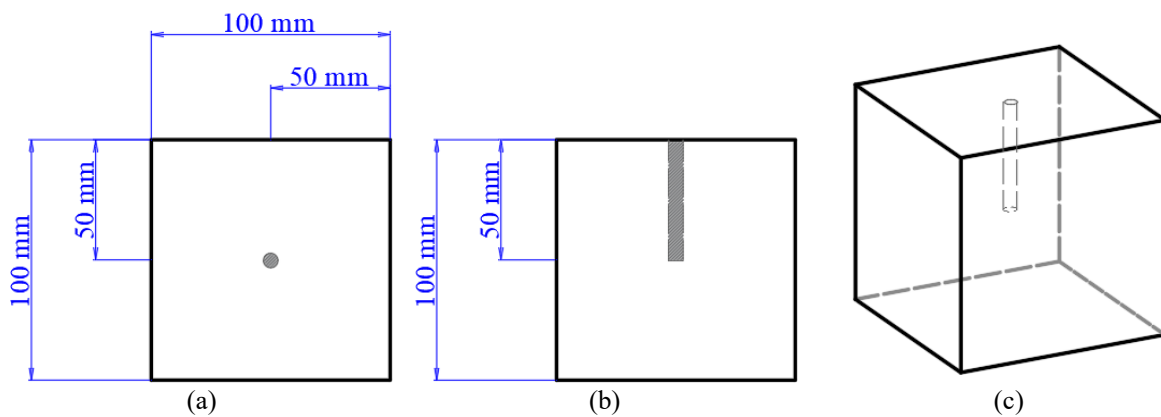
Pormenor do furo para inserção do termopar. (a) Vista superior; (b) Vista lateral; (c) Vista 3D.
